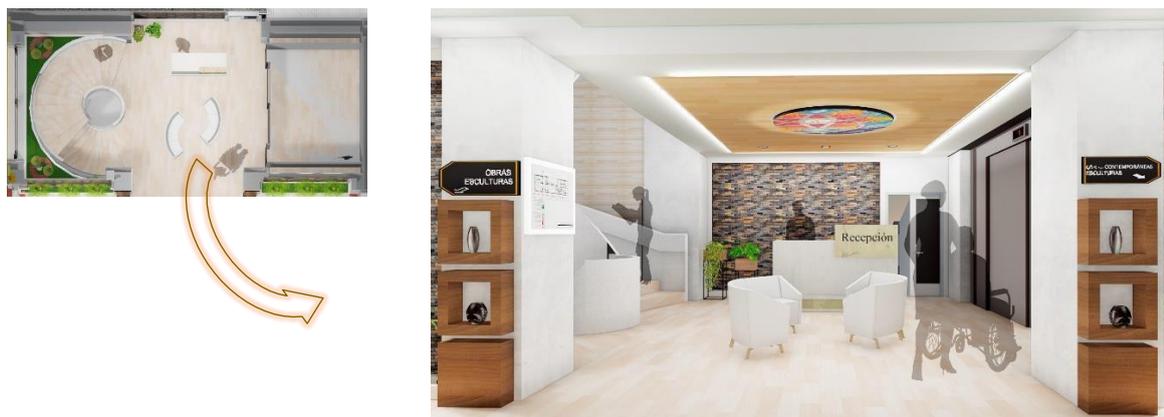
Propuesta de Rediseño de la Recepción, Planta baja.
